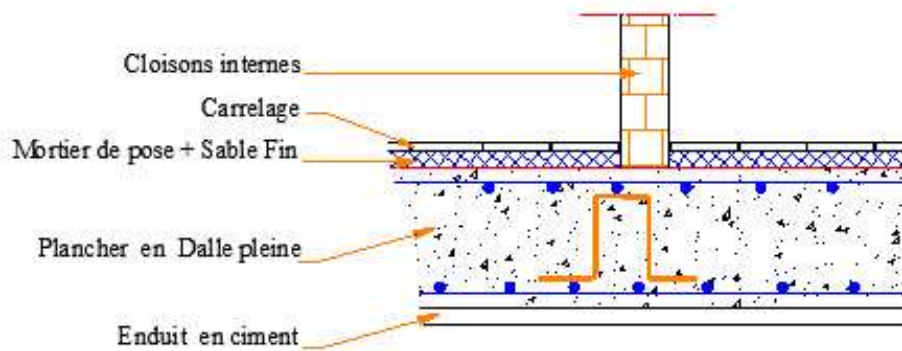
Coupe verticale du plancher étages courants (Dalle pleine)
